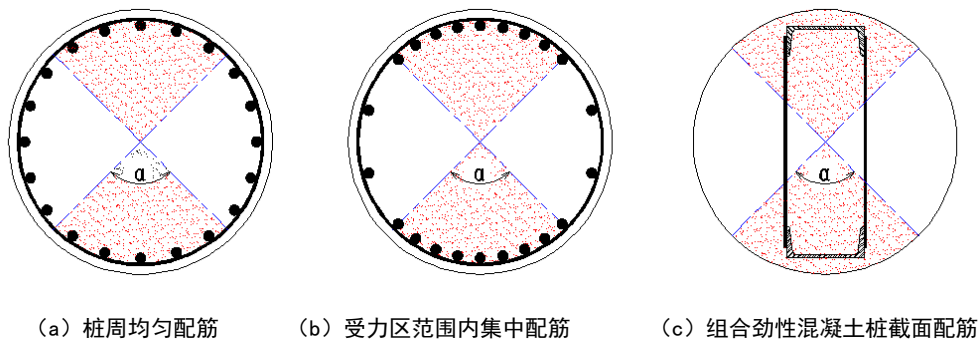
组合劲性混凝土桩与钢筋混凝土桩截面比较
